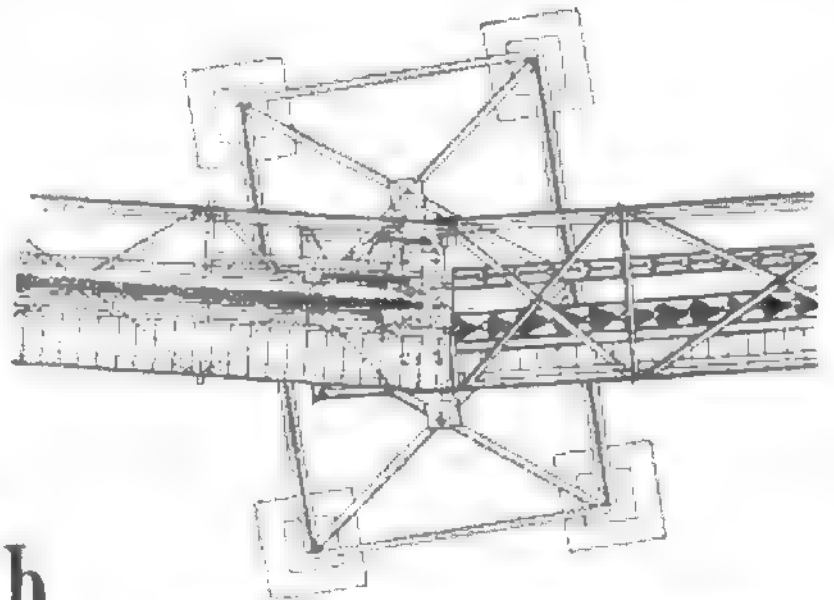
Hauptpfeiler III (vgl. Fig. 609, 613 u. 614): Grundriss.
